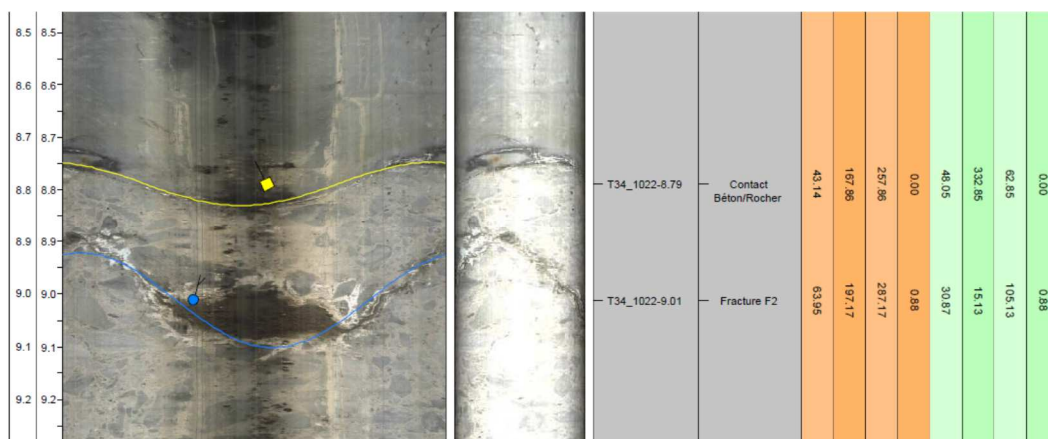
forage T34-1022 (plot 7/8) fissure inclinée à 30,9° par rapport à l'horizontale (en bleu clair), située à 9,01 m du parement aval (ouverture 0,88 mm)
